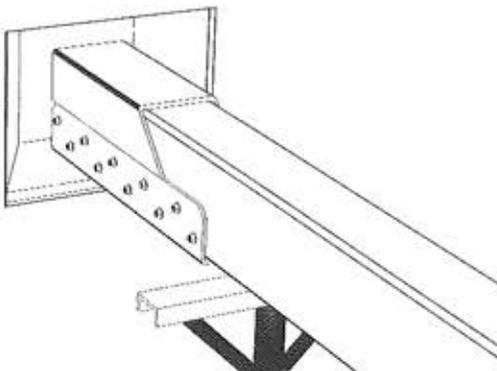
a – Ricostruzione dell'appoggio della trave con protesi interamente d'acciaio.
